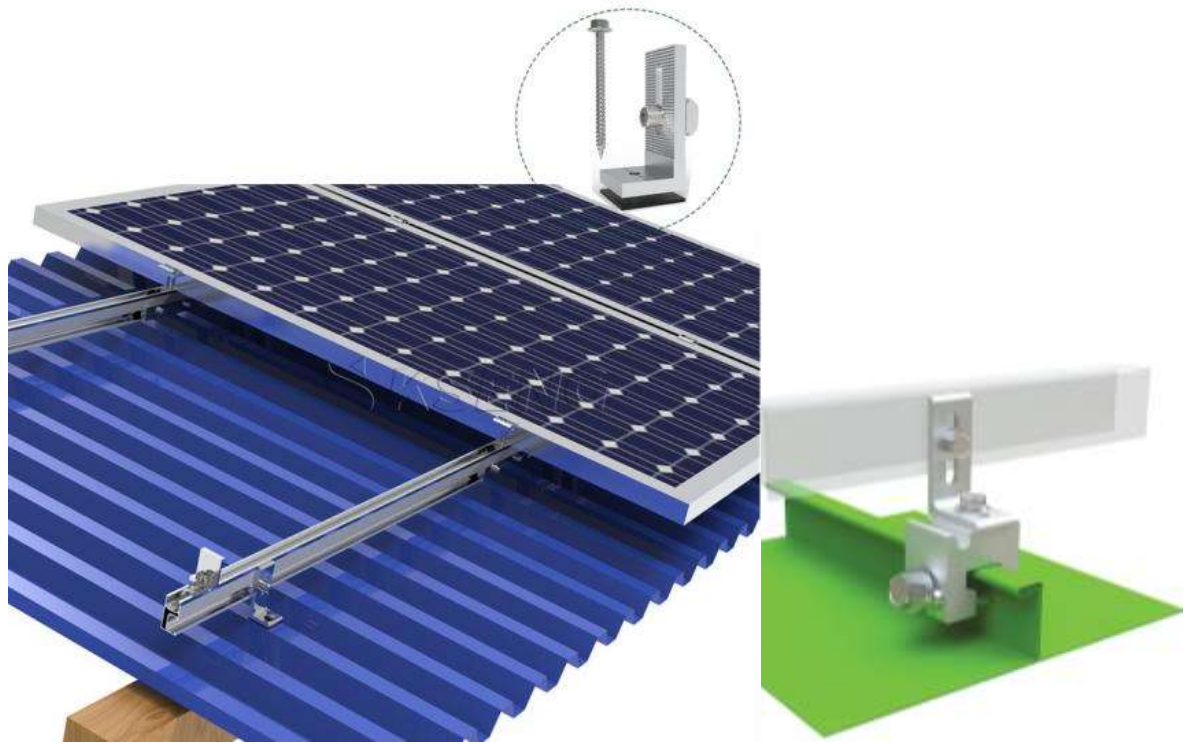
Схема кріплення опорних елементів до даху будівлі
